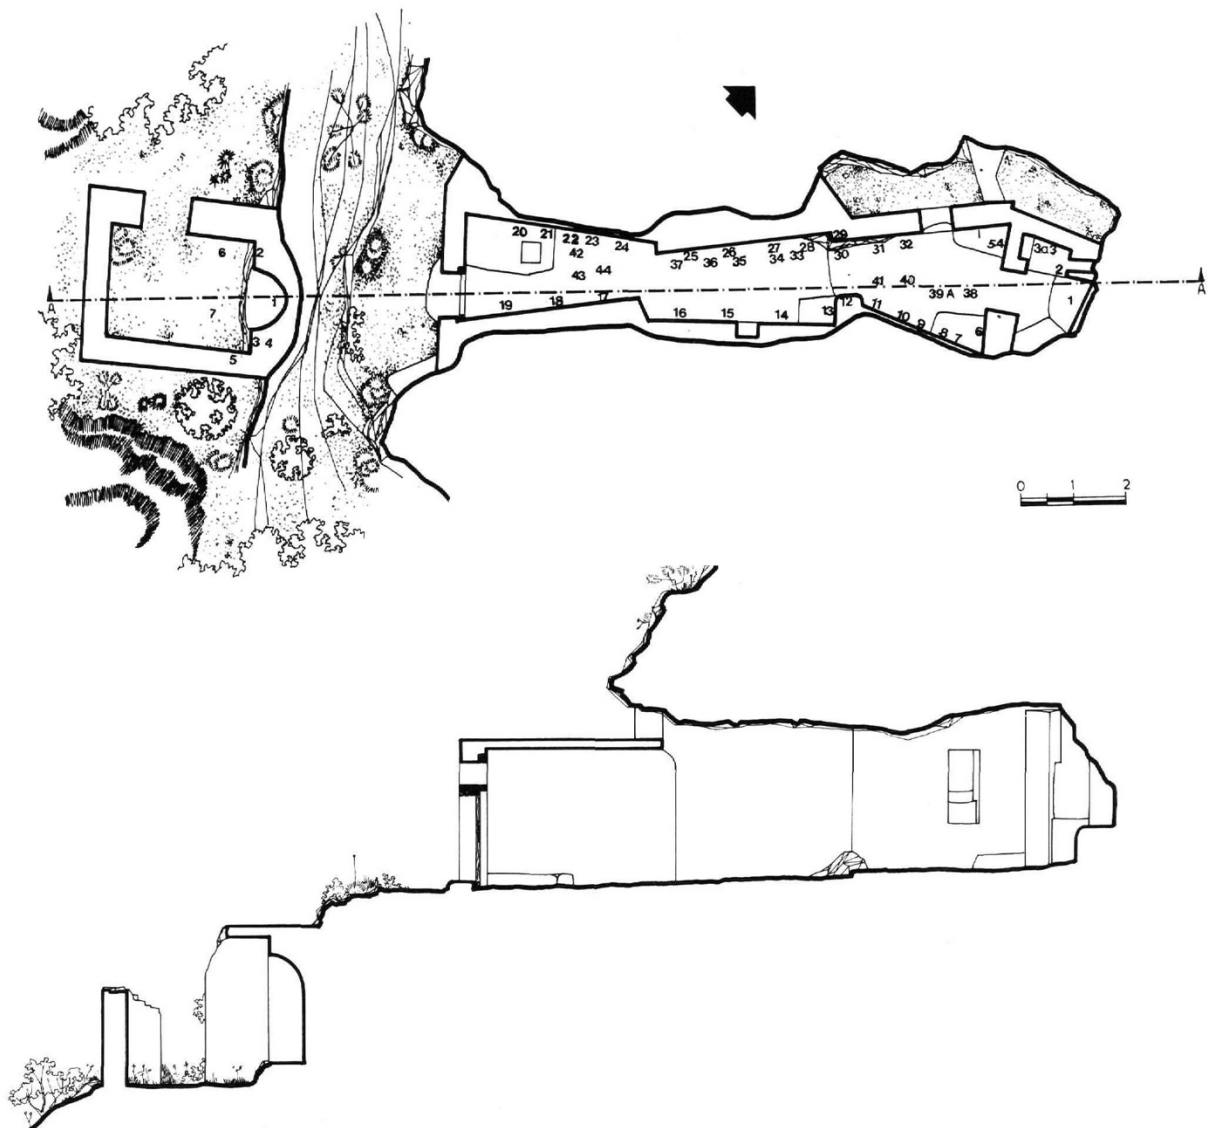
Plan et coupe transversale de l'ermitage Saint-Jean-Baptiste de Tsilioto, près de Chrysafa
